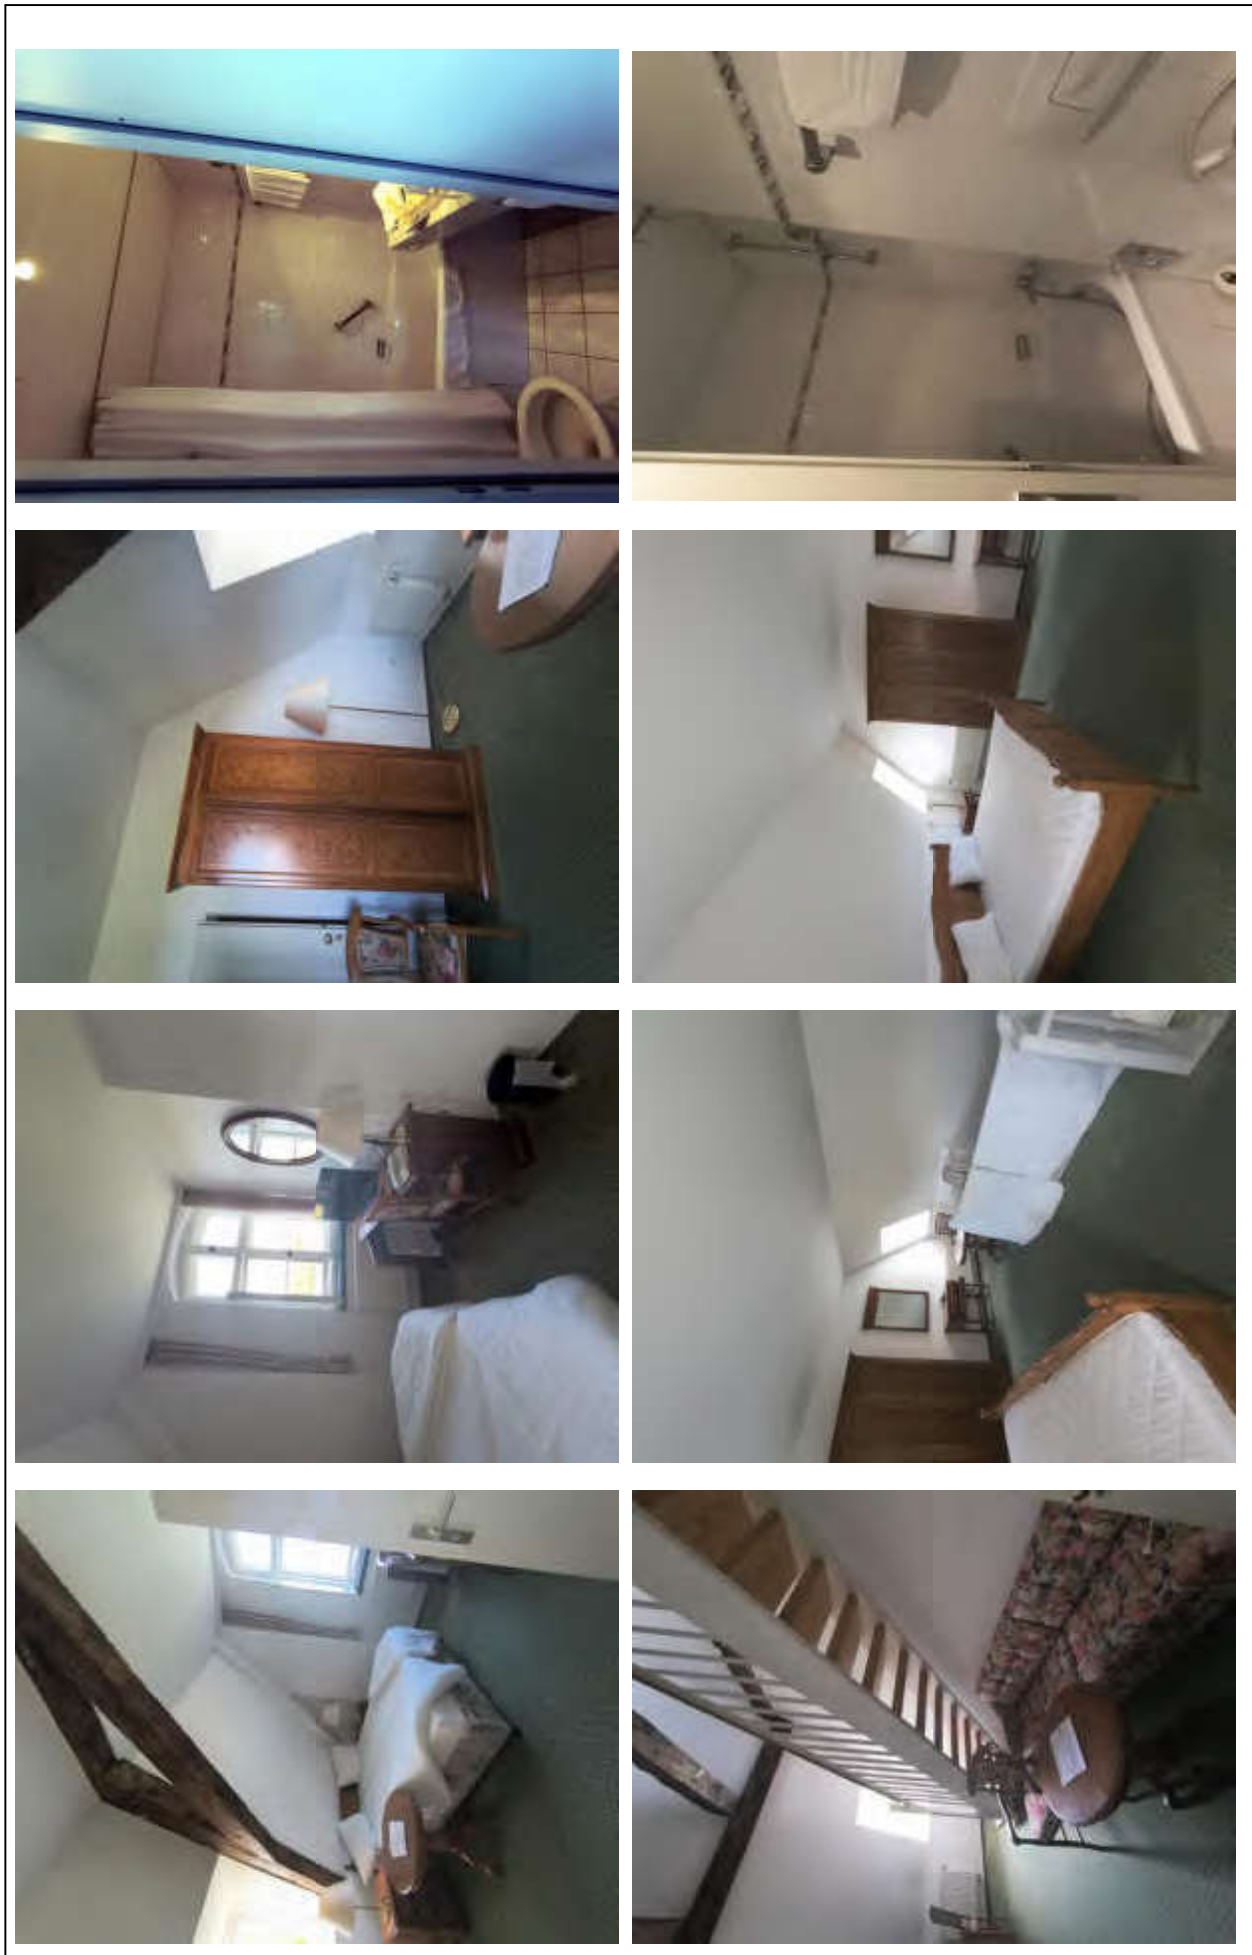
o Oben: Ansichten vom Zimmer 402 im Dachgeschoss (1 Ebene)
